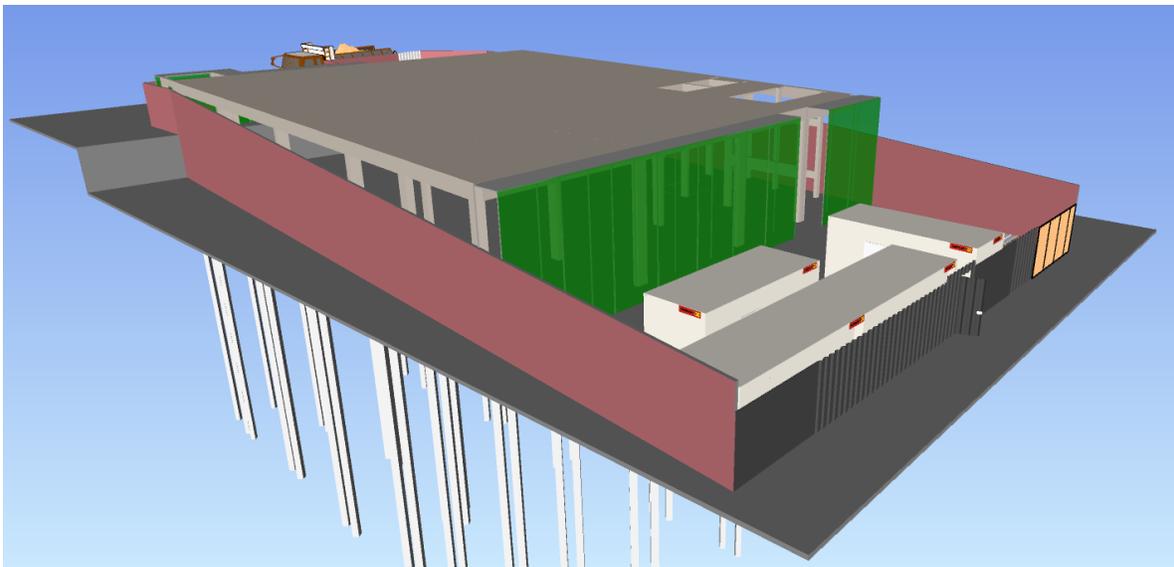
Simulação Navisworks: execução de andaimes fachadeiros e estrutura 2º pavimento
